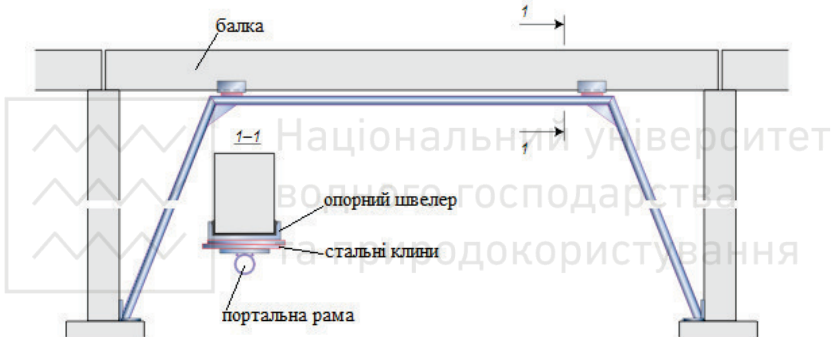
Підсилення залізобетонних балок портальними рамами
